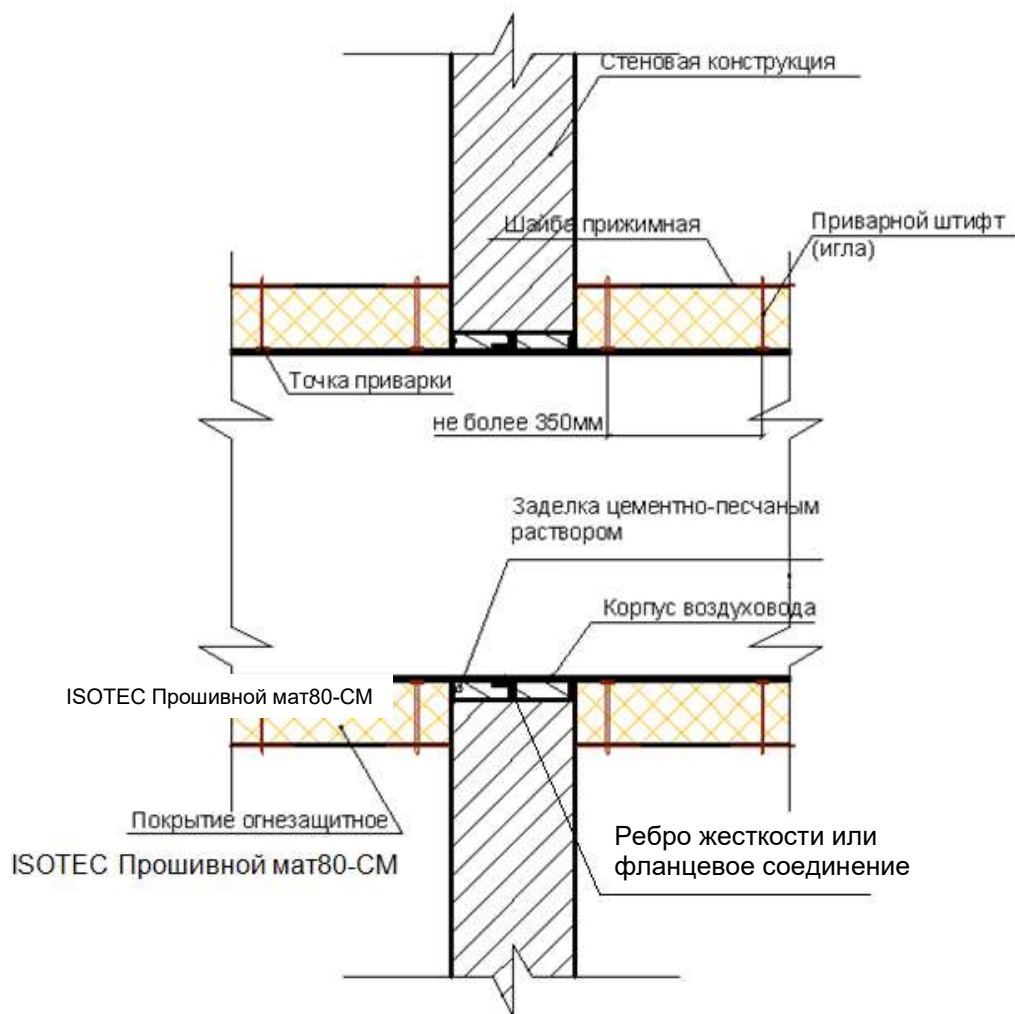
Принципиальная схема пересечения воздуховодом строительной конструкции
